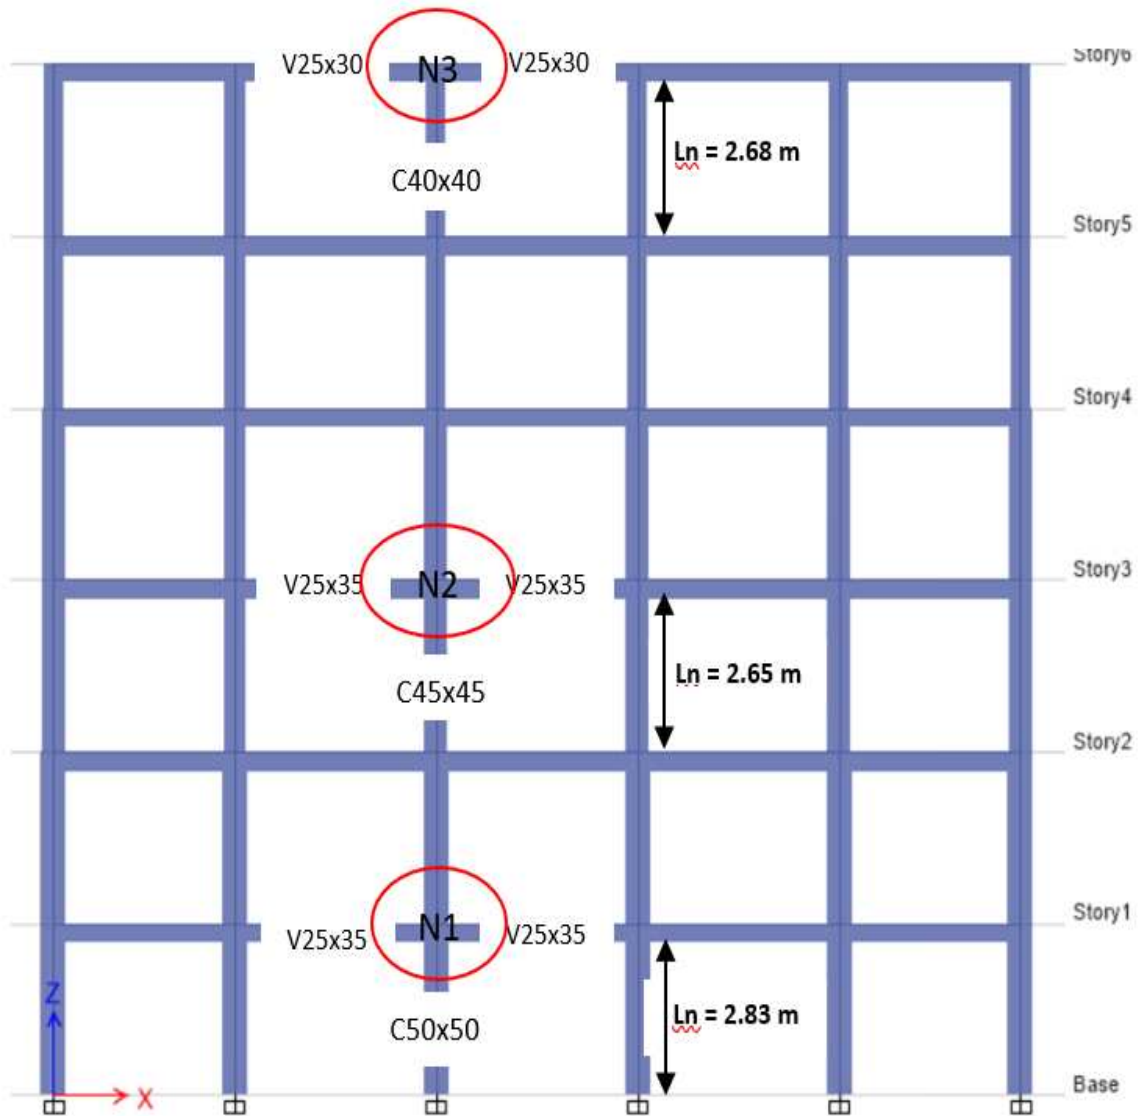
Vista Frontal Edificio de 6 pisos, secciones de columnas
